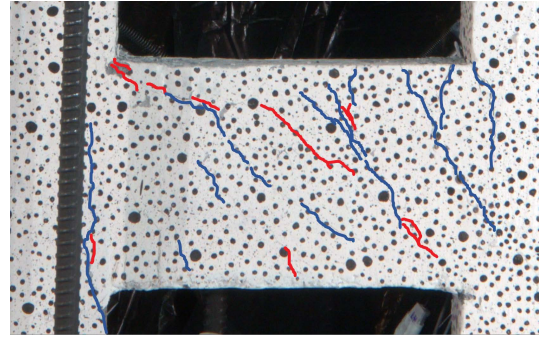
Grietas Vigas a 0.9% Drift
